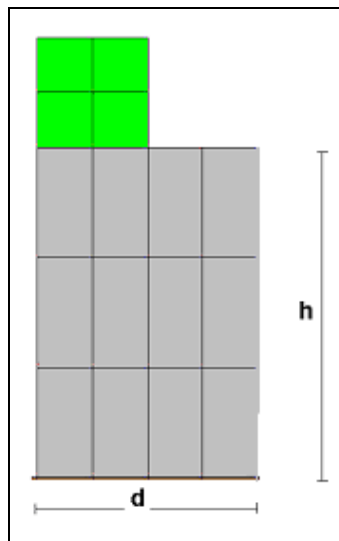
Cálculo de la flexibilidad de un Estribo o Pila.
